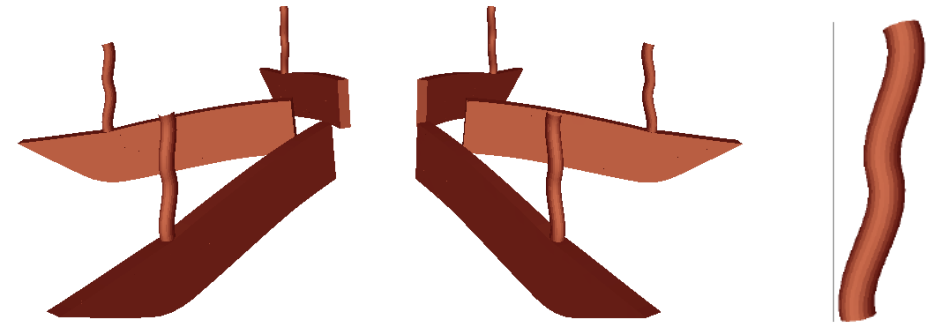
Deformación de los soportes. Izquierda: conjunto de los pilares junto con las vigas sobre las que apoyan. Derecha: Ampliación de uno de los pilares donde se aprecia la deformación en forma de S respecto de la vertical
